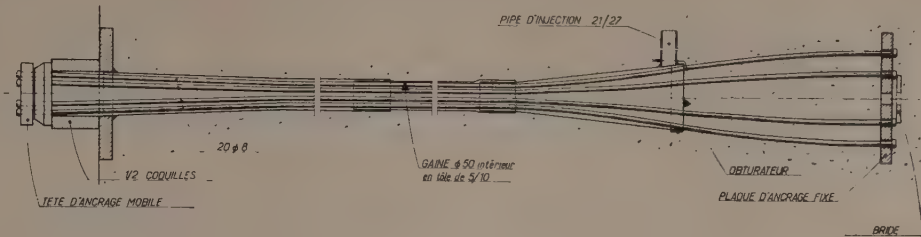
Schéma d'un câble type BBR-Boussiron.
